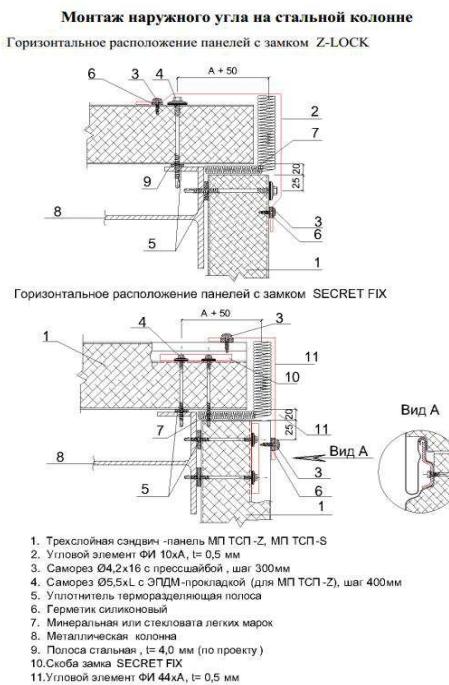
Монтаж наружного угла на стальной колонне
